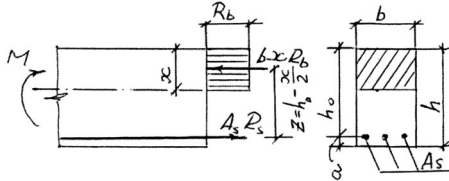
Расчетная схема для подбора продольной арматуры в балках (плитах) прямоугольного поперечного сечения с одиночной арматурой
